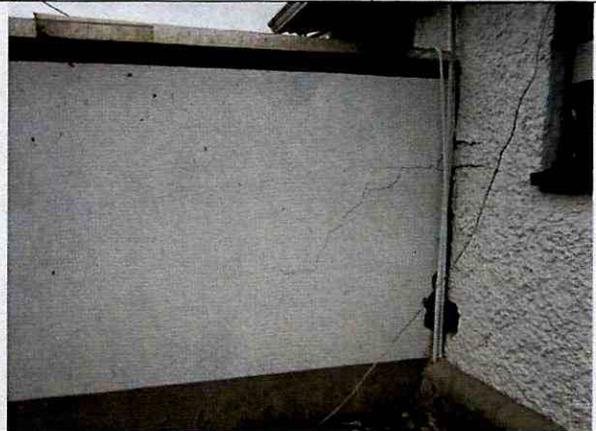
Grietas en muros de la ampliación adosada.
